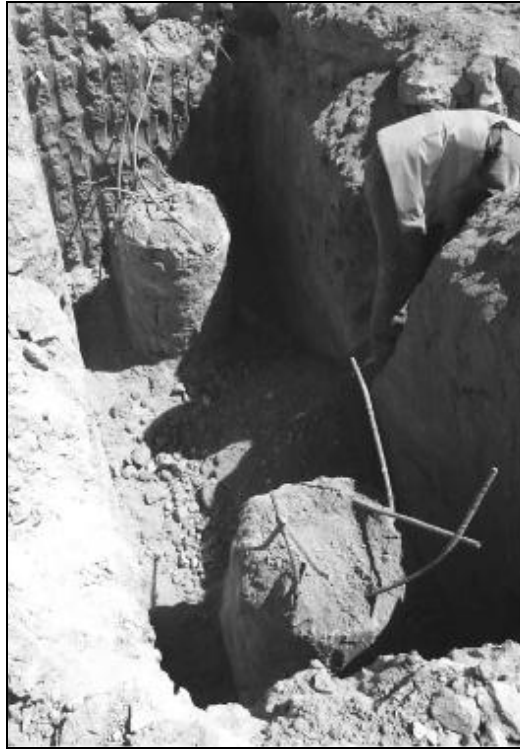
Excavación de encepado de dos pilotes.⁽²⁶⁾
